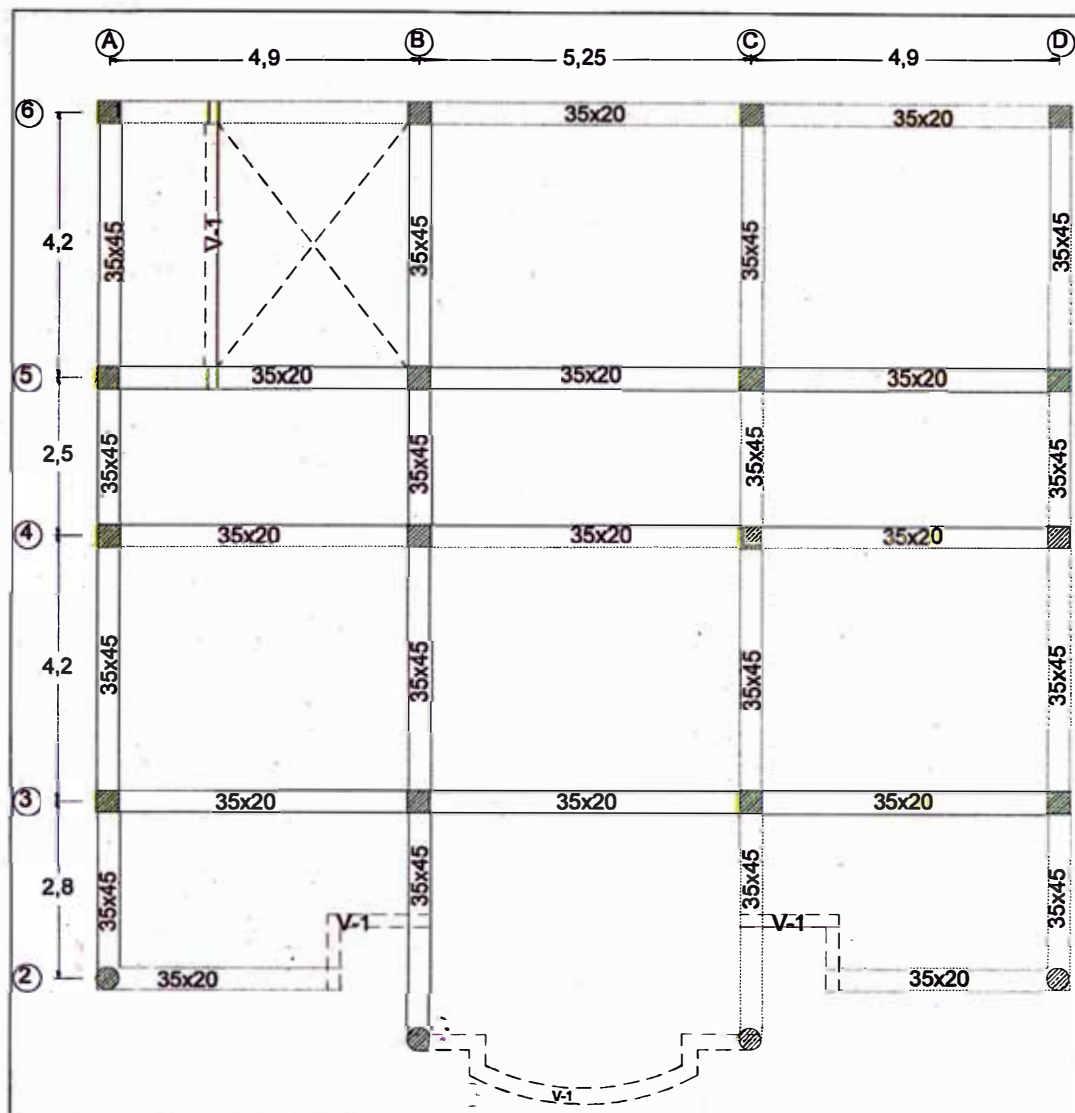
Planta cuarto piso del edificio municipal – elementos estructurales
